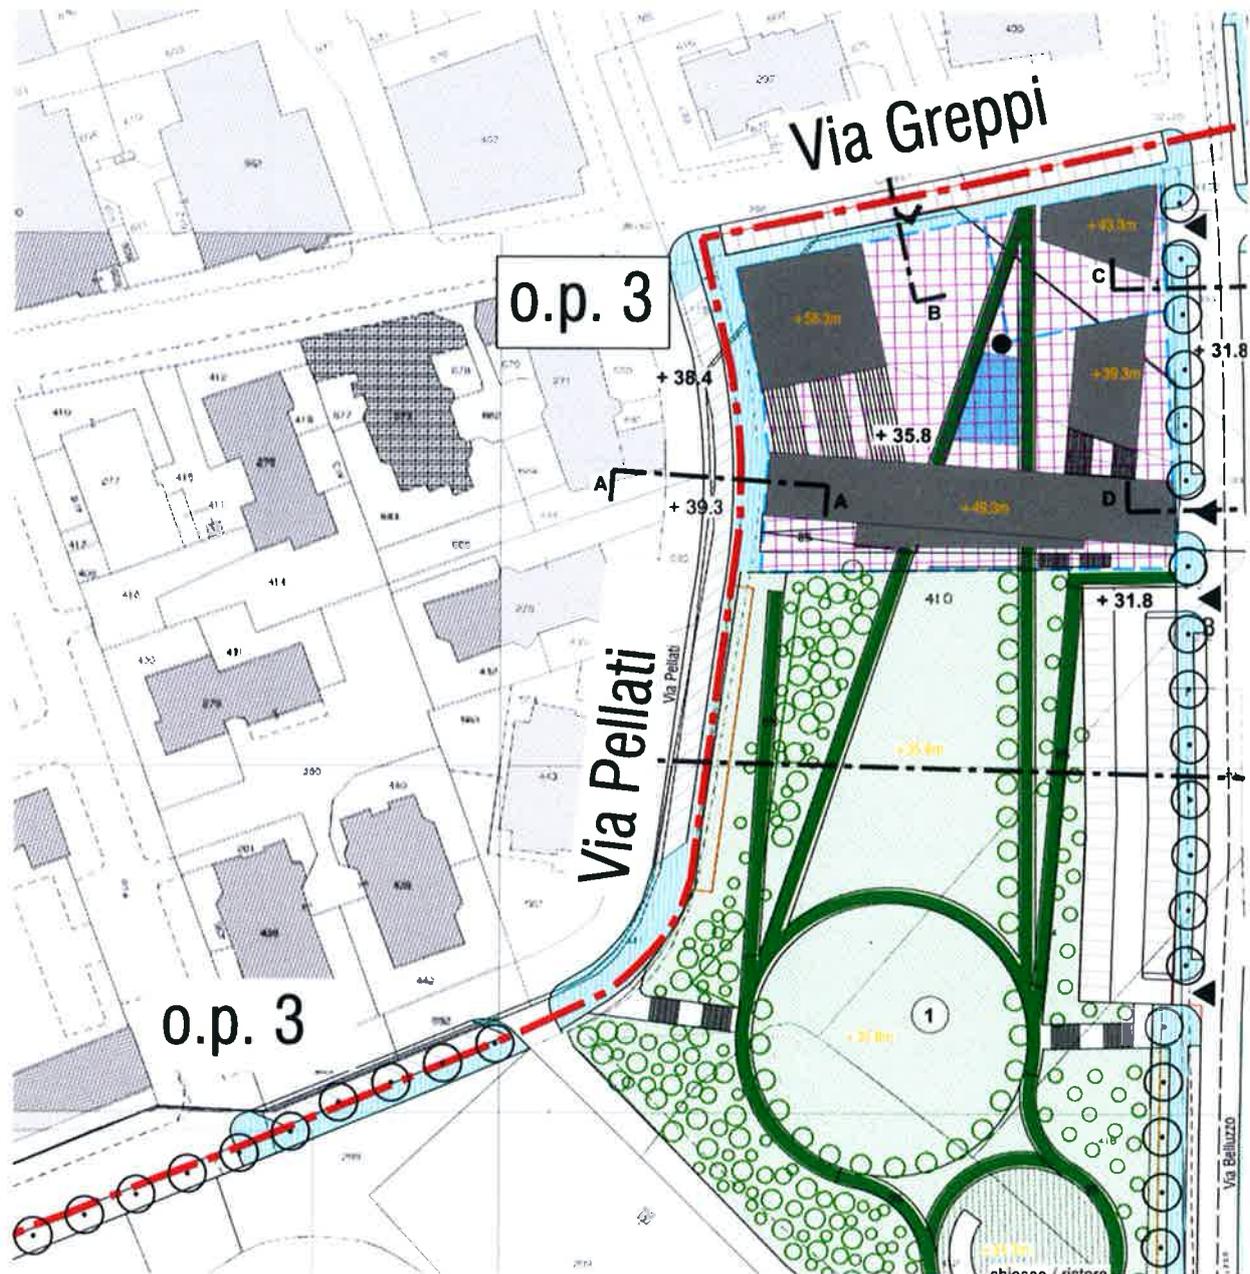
Inquadramento planimetrico dell'opera pubblica n. 3.
